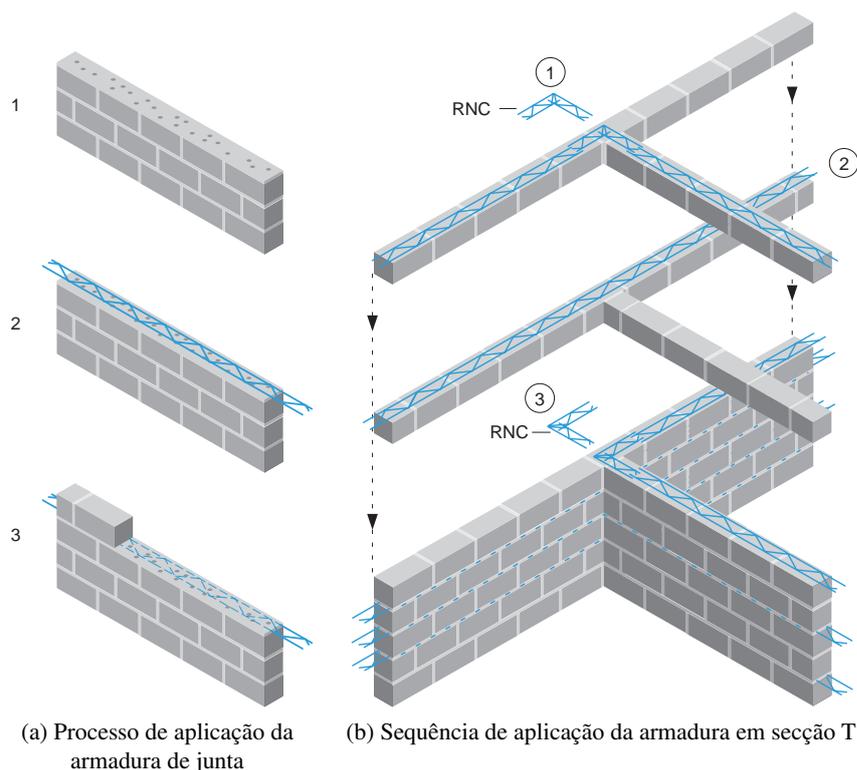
Processos de aplicação da armadura de junta (Adaptado, Murfor, 2013)
